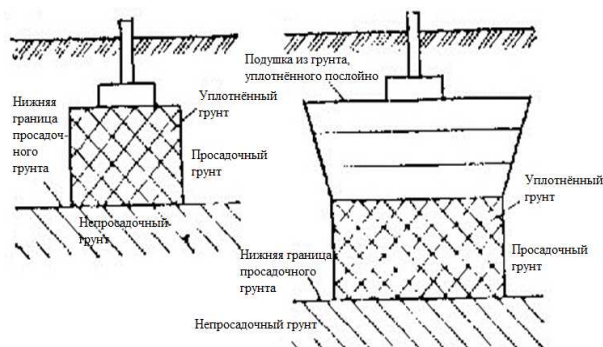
Конструктивные решения фундаментов, возводимых на просадочных грунтах в основании I типа.
